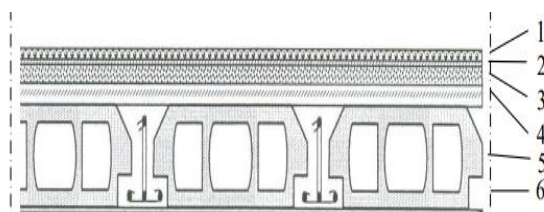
Schéma représentant les couches d'un plancher de terrasse inaccessible
